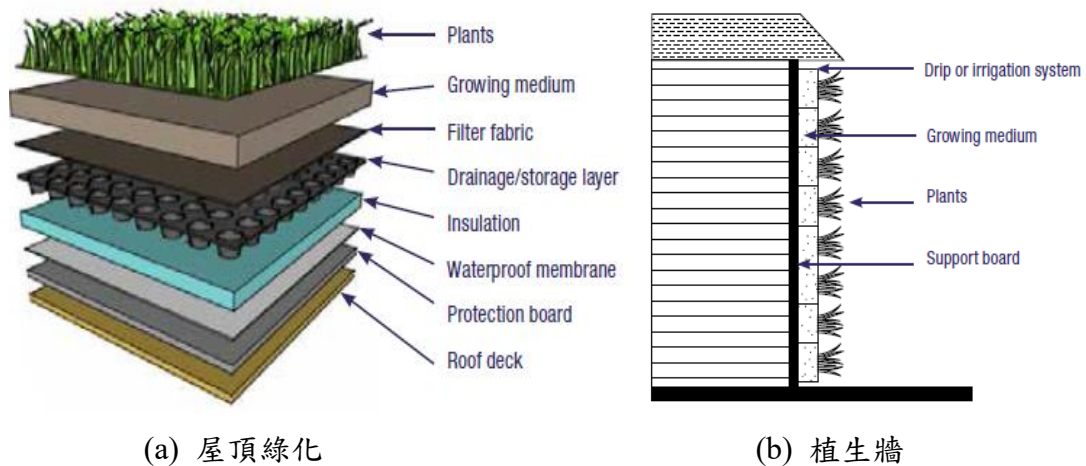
11 Green Roofs(屋頂綠化)與 Green Walls(植生牆)剖面示意圖
